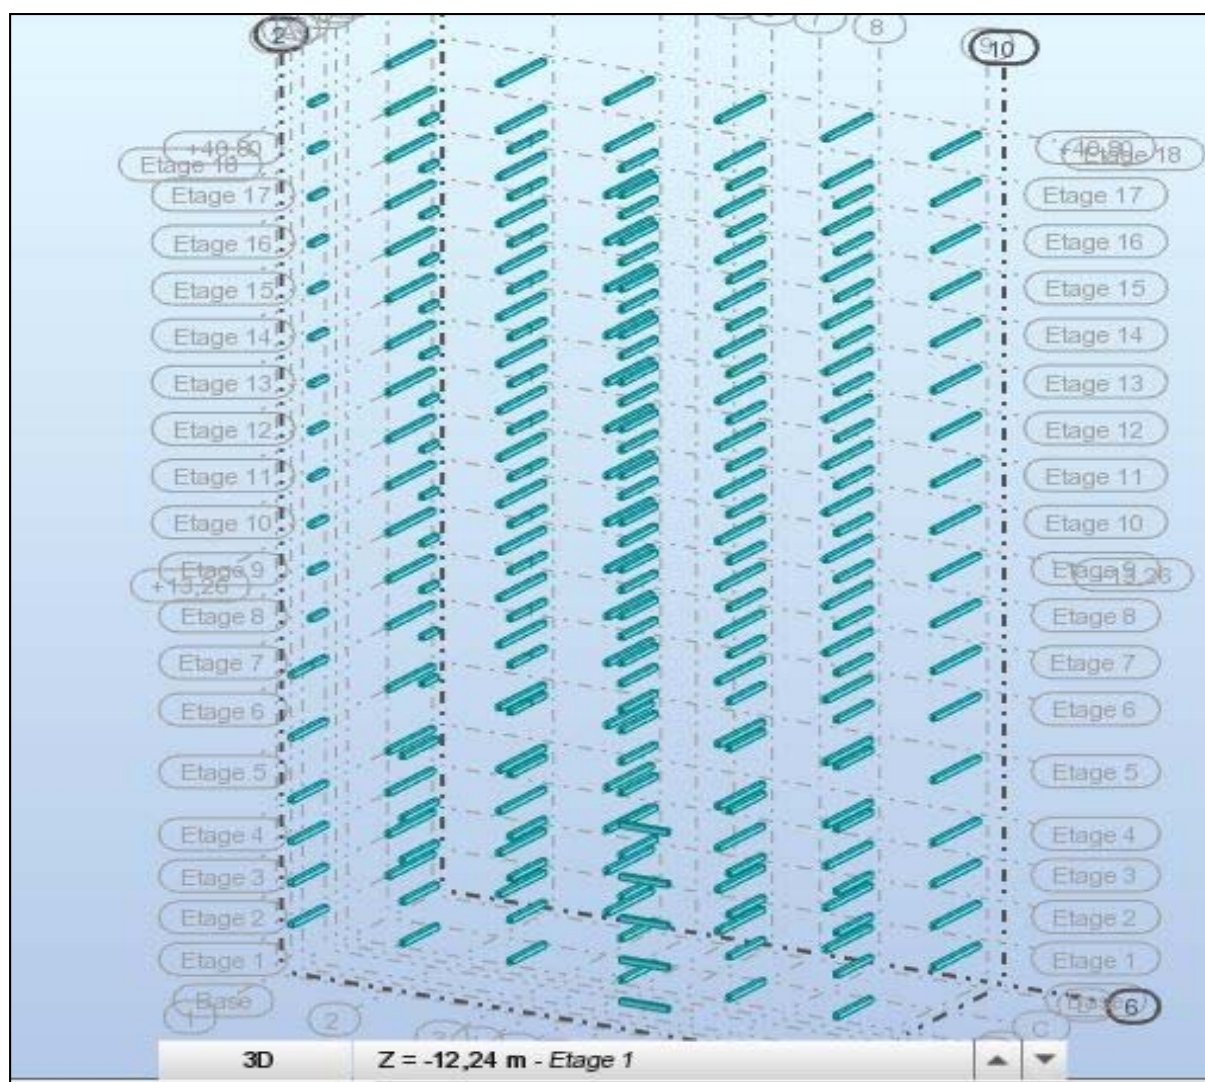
Vue En 3d Poutres Secondaire De La Structures (30x35)
